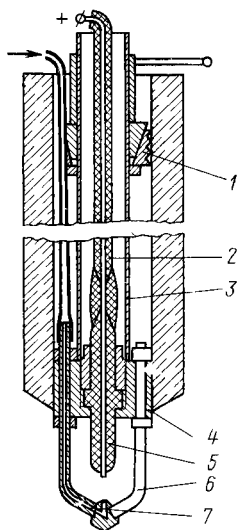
Электрогидравлическое устройство для погружения полых свай. / — механизм крепления устройства в свае, 2 — высоковольтный кабель, 3 — трубчатый корпус устройства, 4 — корпус разрядной головки, 5 — положительный электрод, 6 — отрицательный электрод, 7 — канал для подачи воды в зону разряда
